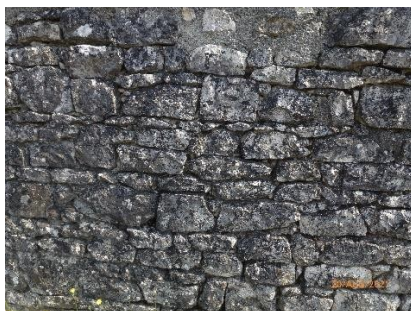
Mur en pierre de taille, (photo Urbanea, 2021)
